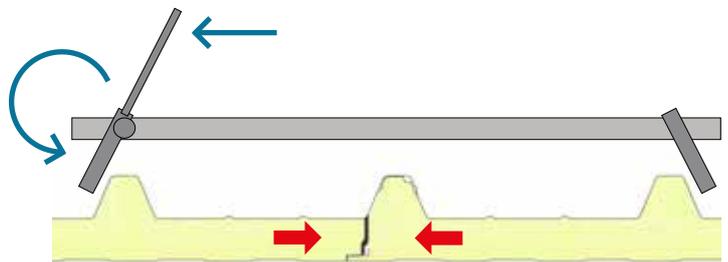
Uso de dispositivos auxiliares para paneles de cubierta: el sistema de cierre de las juntas para facilitar la fijación.
